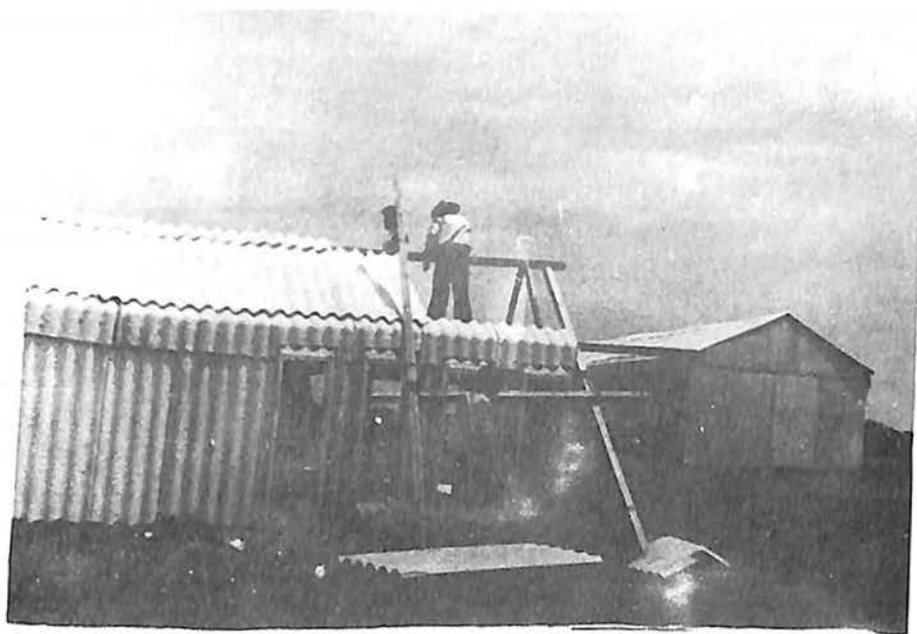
CONSTRUCCIÓN DE LA CASA DESTINADA A
